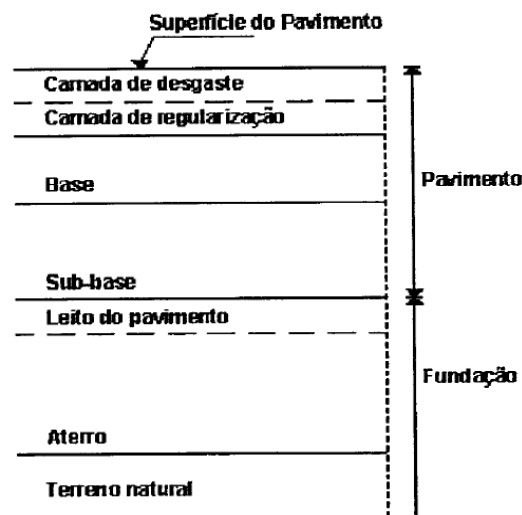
1 - Constituição de uma estrutura tipo de um pavimento rodoviário [9].
